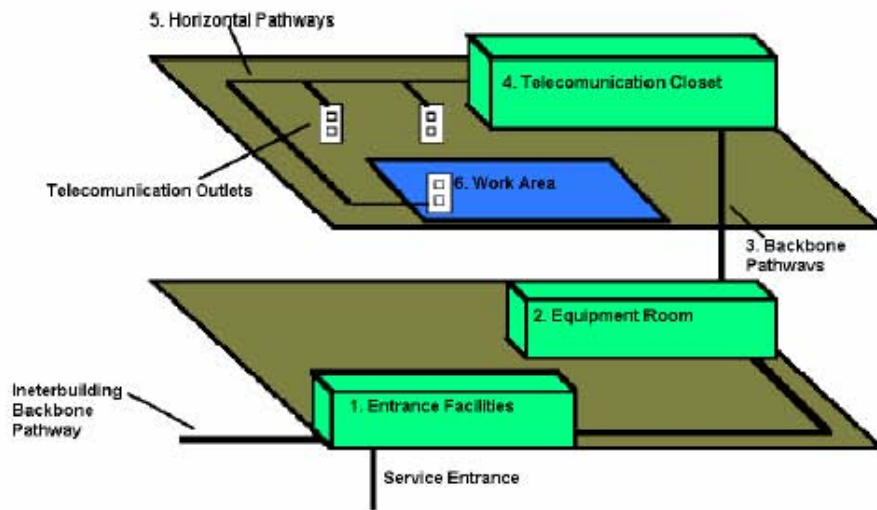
Los seis componentes de un Cableado Estructurado.
